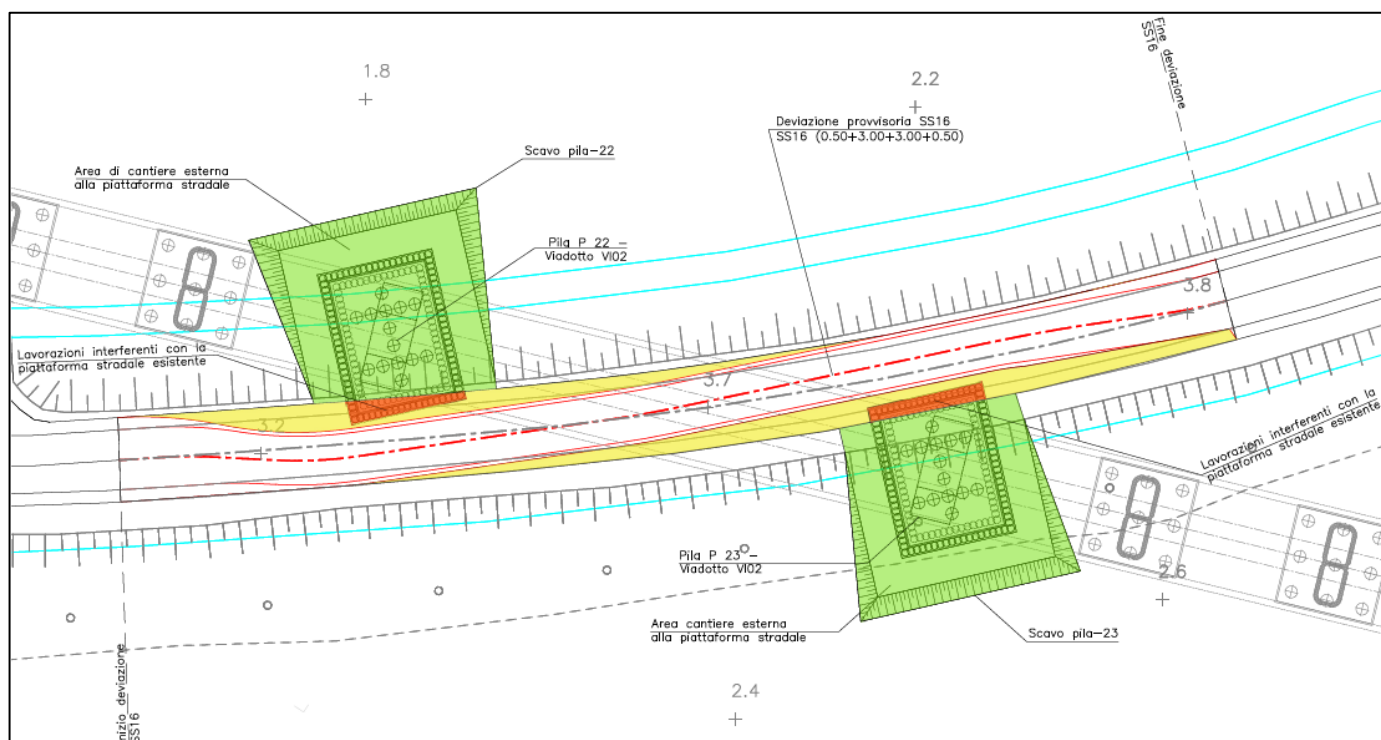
Planimetria deviazione provvisoria in sede fasi realizzazione VI02
